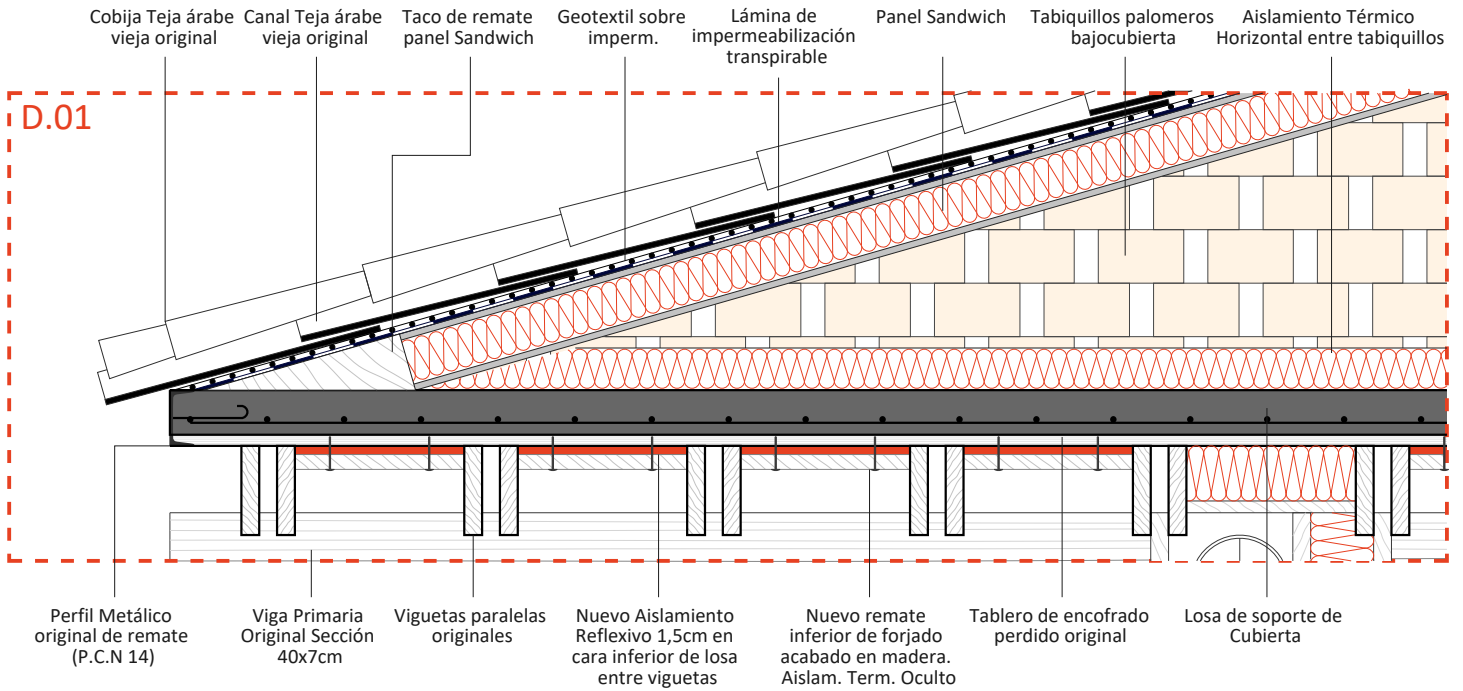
Detalle constructivo Casa Santonja, estado original. Elaboración propia.
